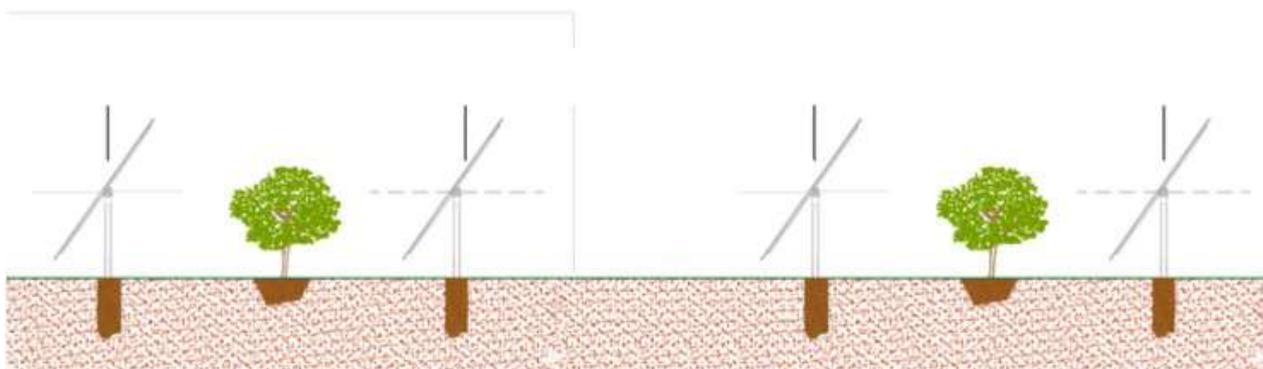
Disposizione oliveto all'interno dell'impianto fotovoltaico oggetto di investimento.
